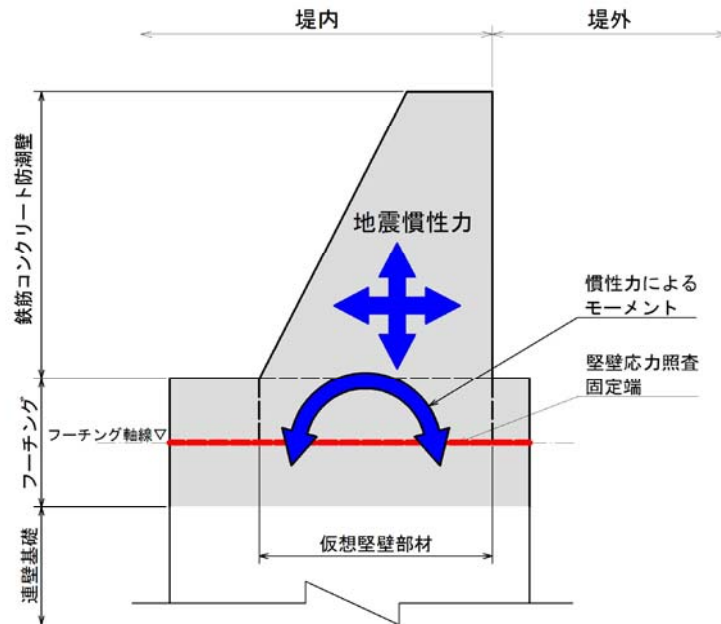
鉄筋コンクリート防潮壁のモデル概念図
